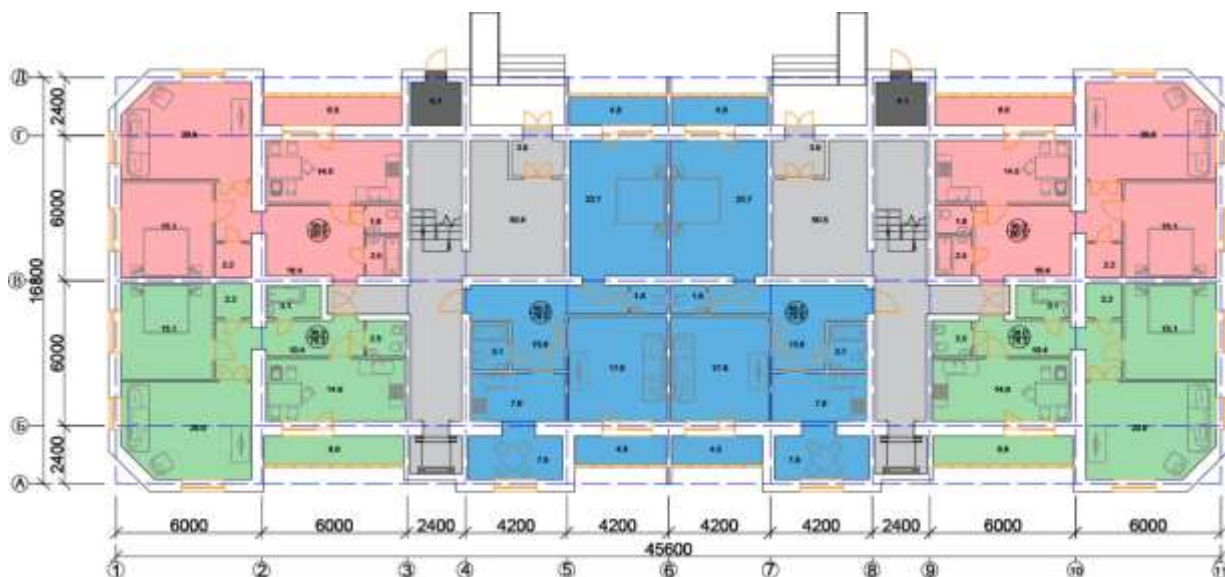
План 1-го этажа 2-2-2-2-2-2. Первый вариант реконструкции серии 1-447
